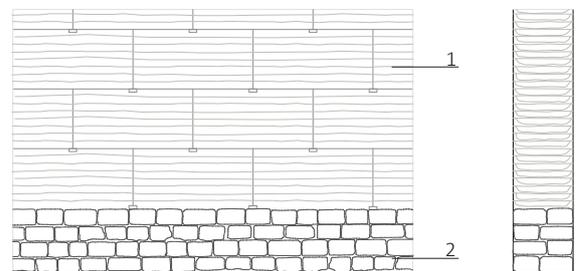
Detalle muro de tapia calicostrada Fuente: propia
